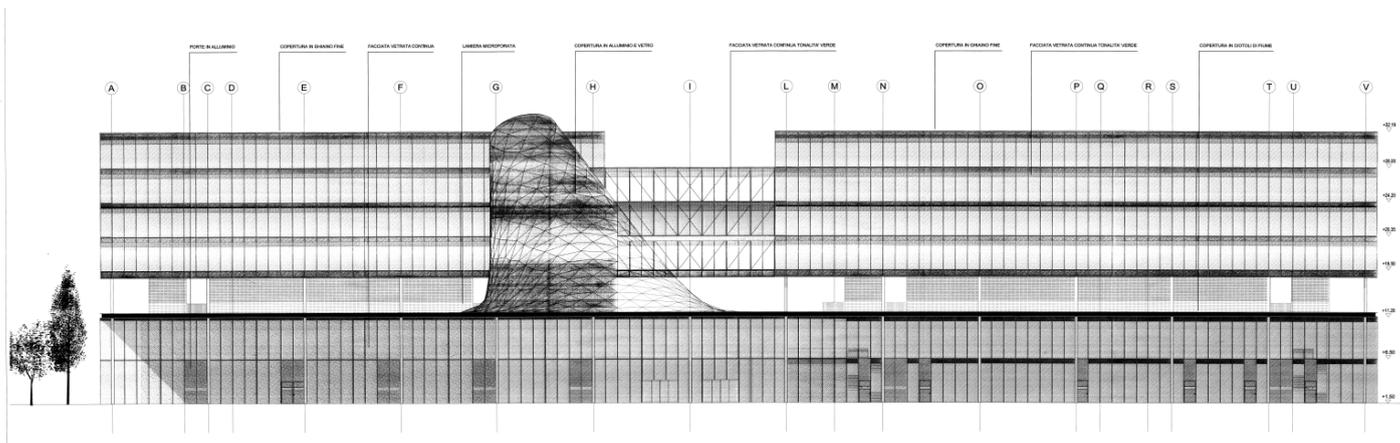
stato di fatto: il prospetto visto da porta sud -
